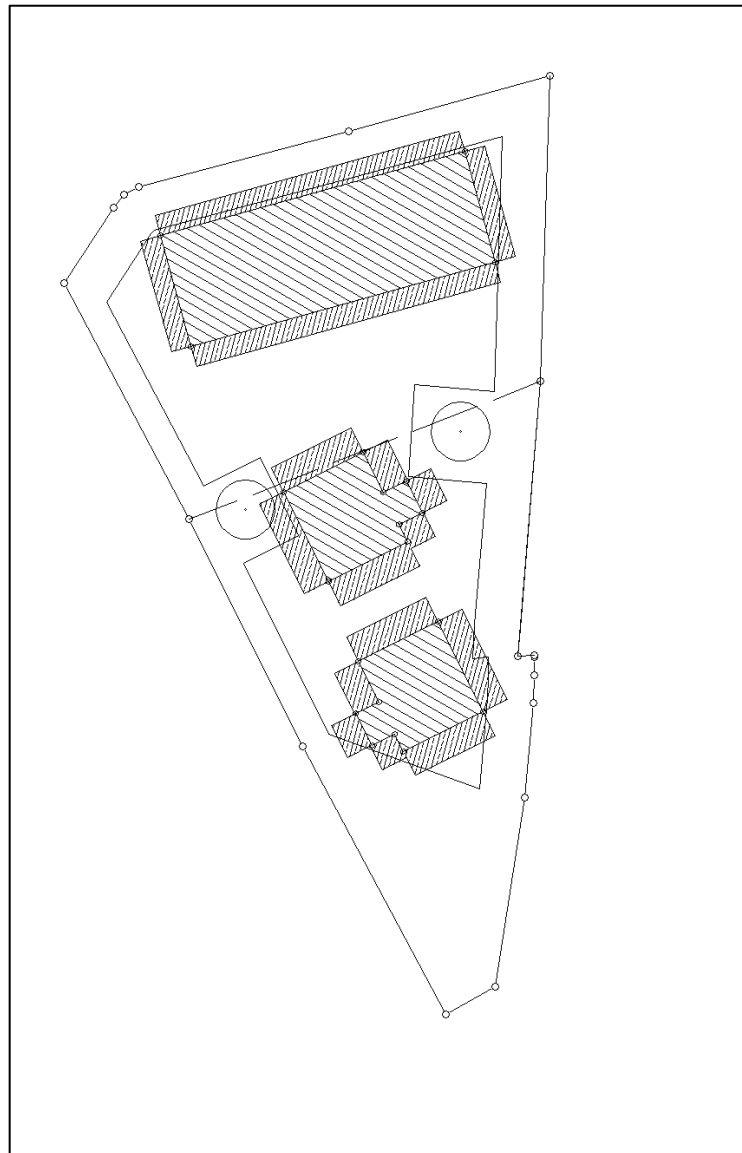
Grundstück mit Baufeld und Abstandsflächen (ohne Maßstab)
